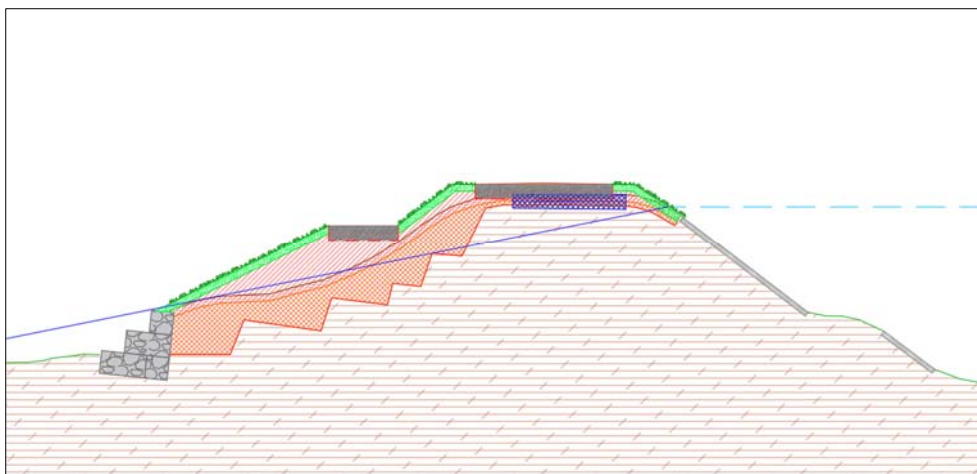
Sezione tipo di progetto in seguito alla posa dei gabbioni.
